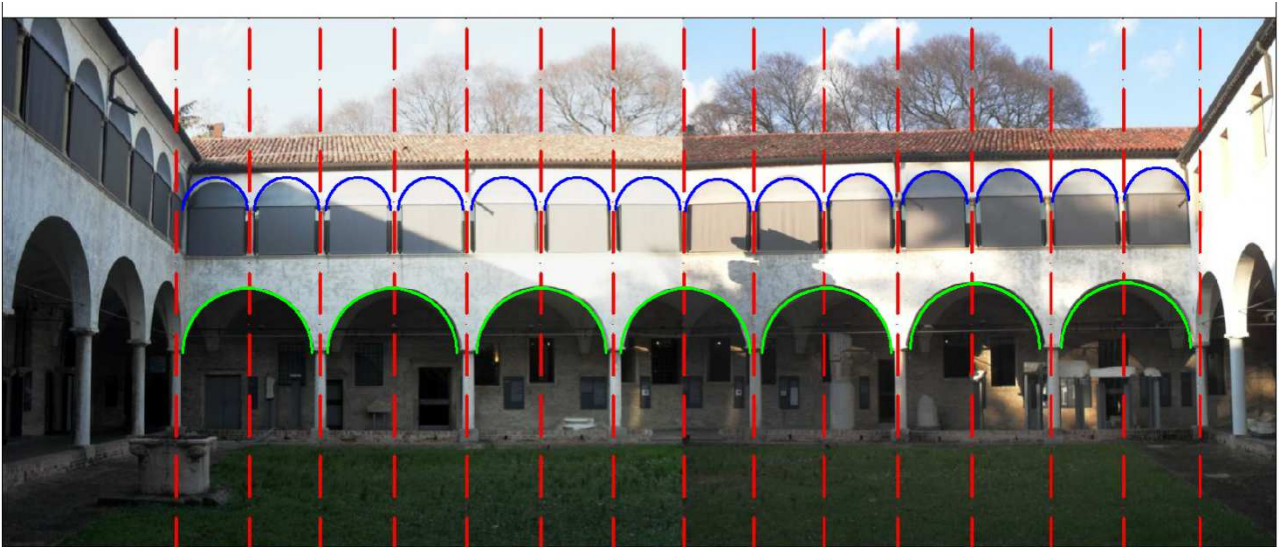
Prospetto Nord, disposizione degli archi del loggiato superiore (in blu) rispetto al portico inferiore (in verde).
